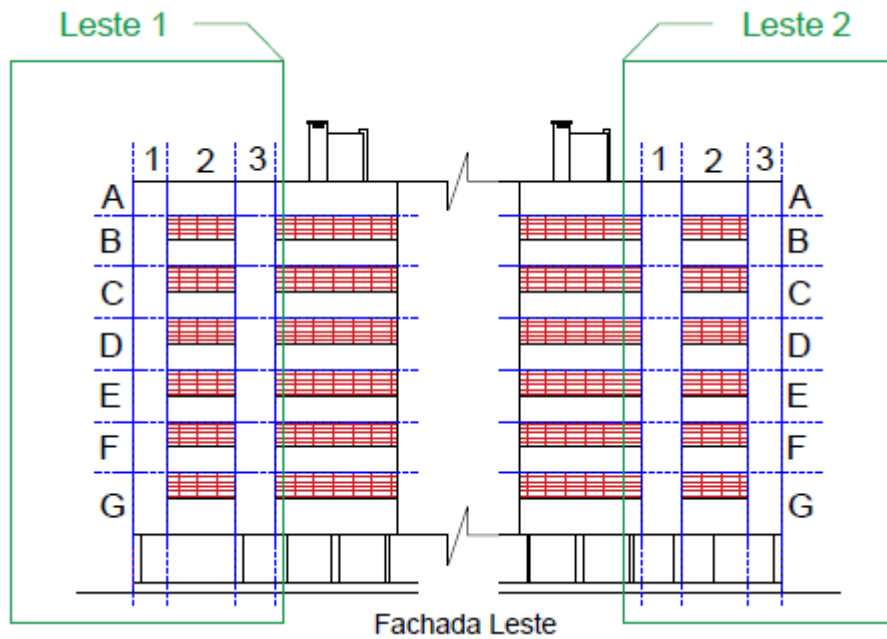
Divisão das regiões da Fachada Leste 1 e da Fachada Leste 2 (Edifício A).
